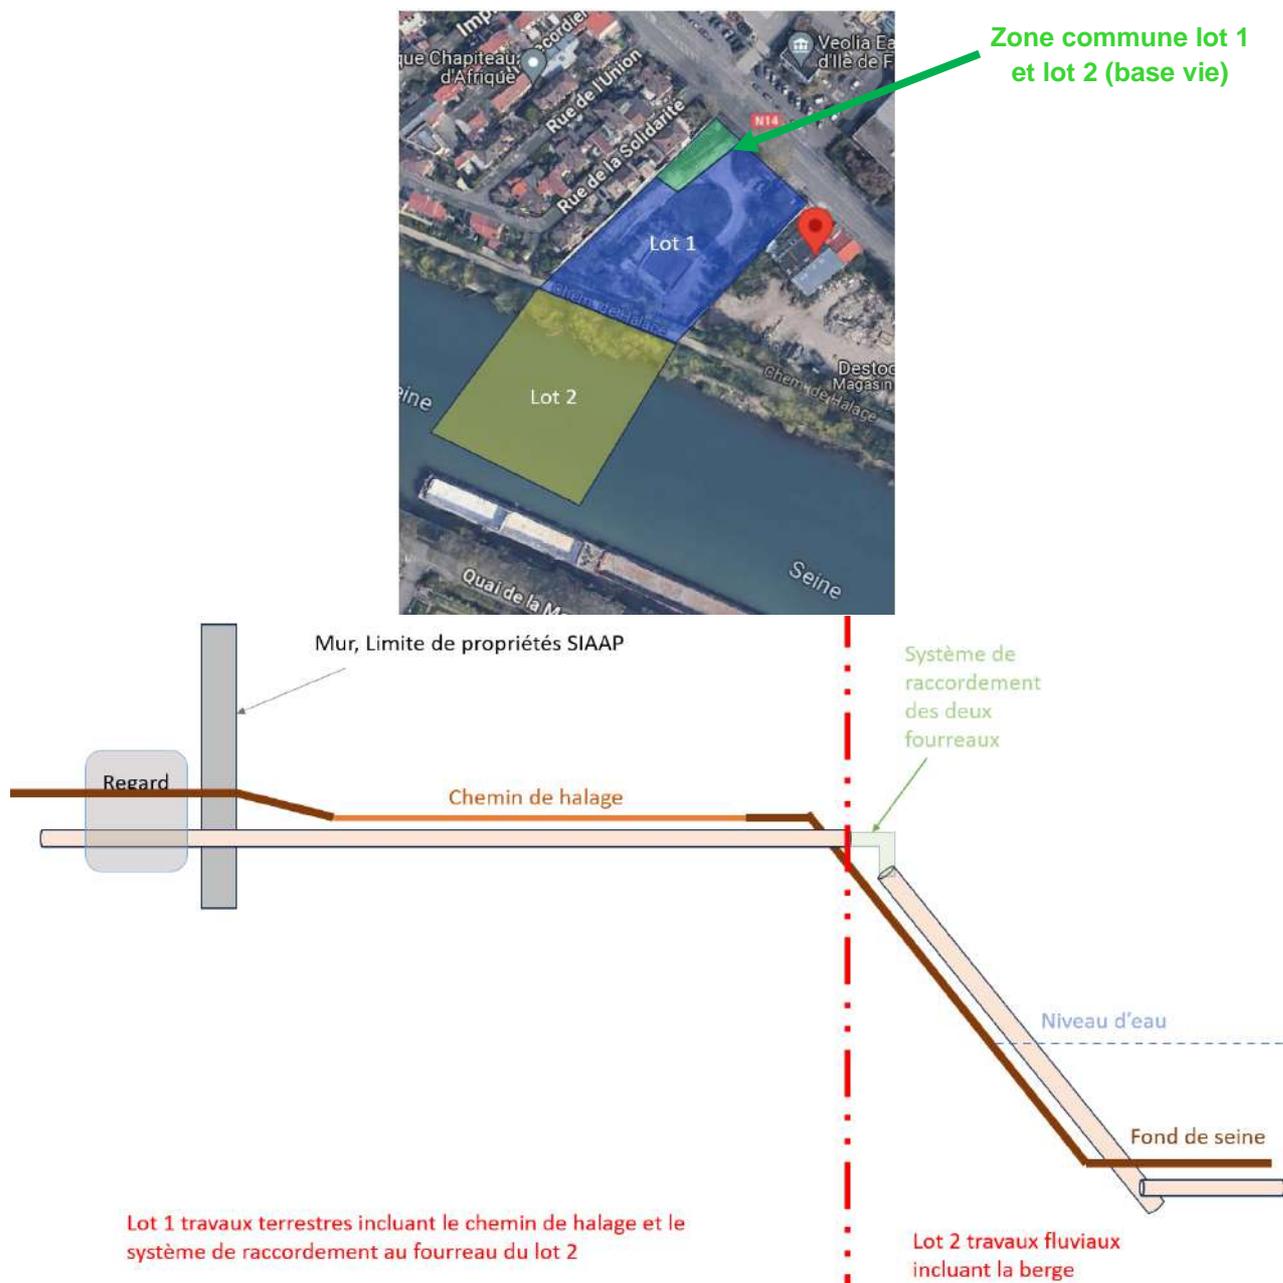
Vue en plan et coupe des limites entre les lots 1 et 2.
